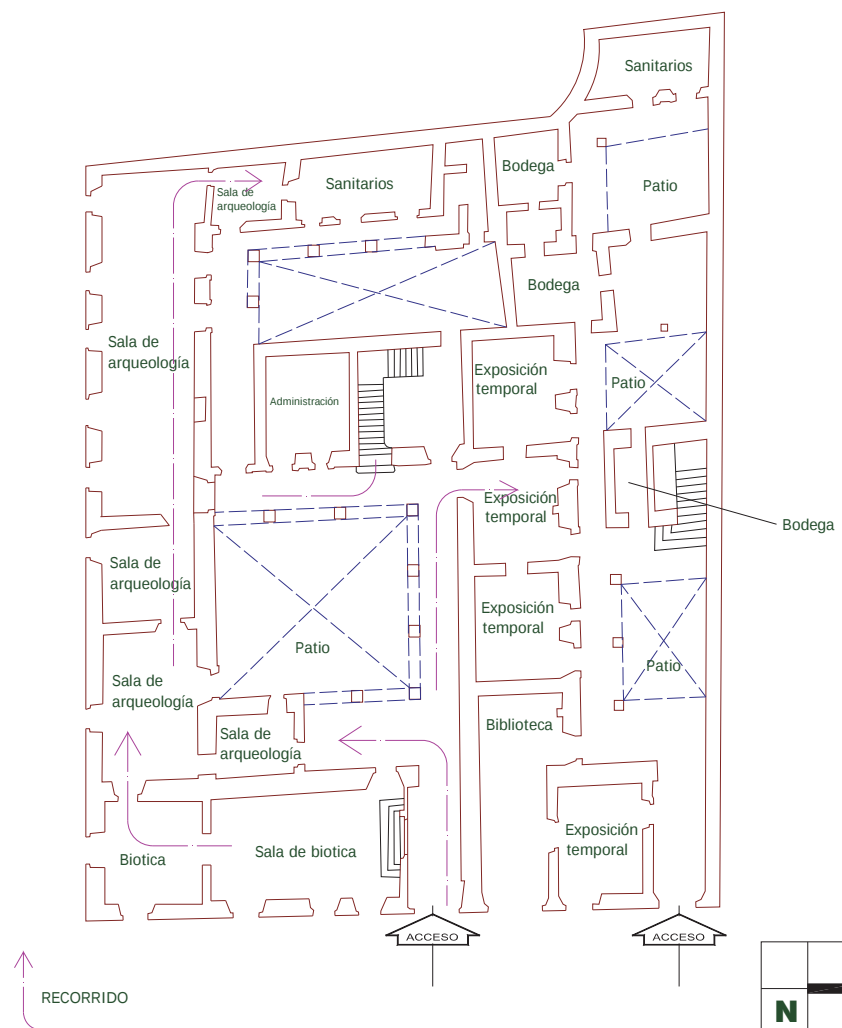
Planta baja del Museo del Estado, salas, circulaciones y servicios.
